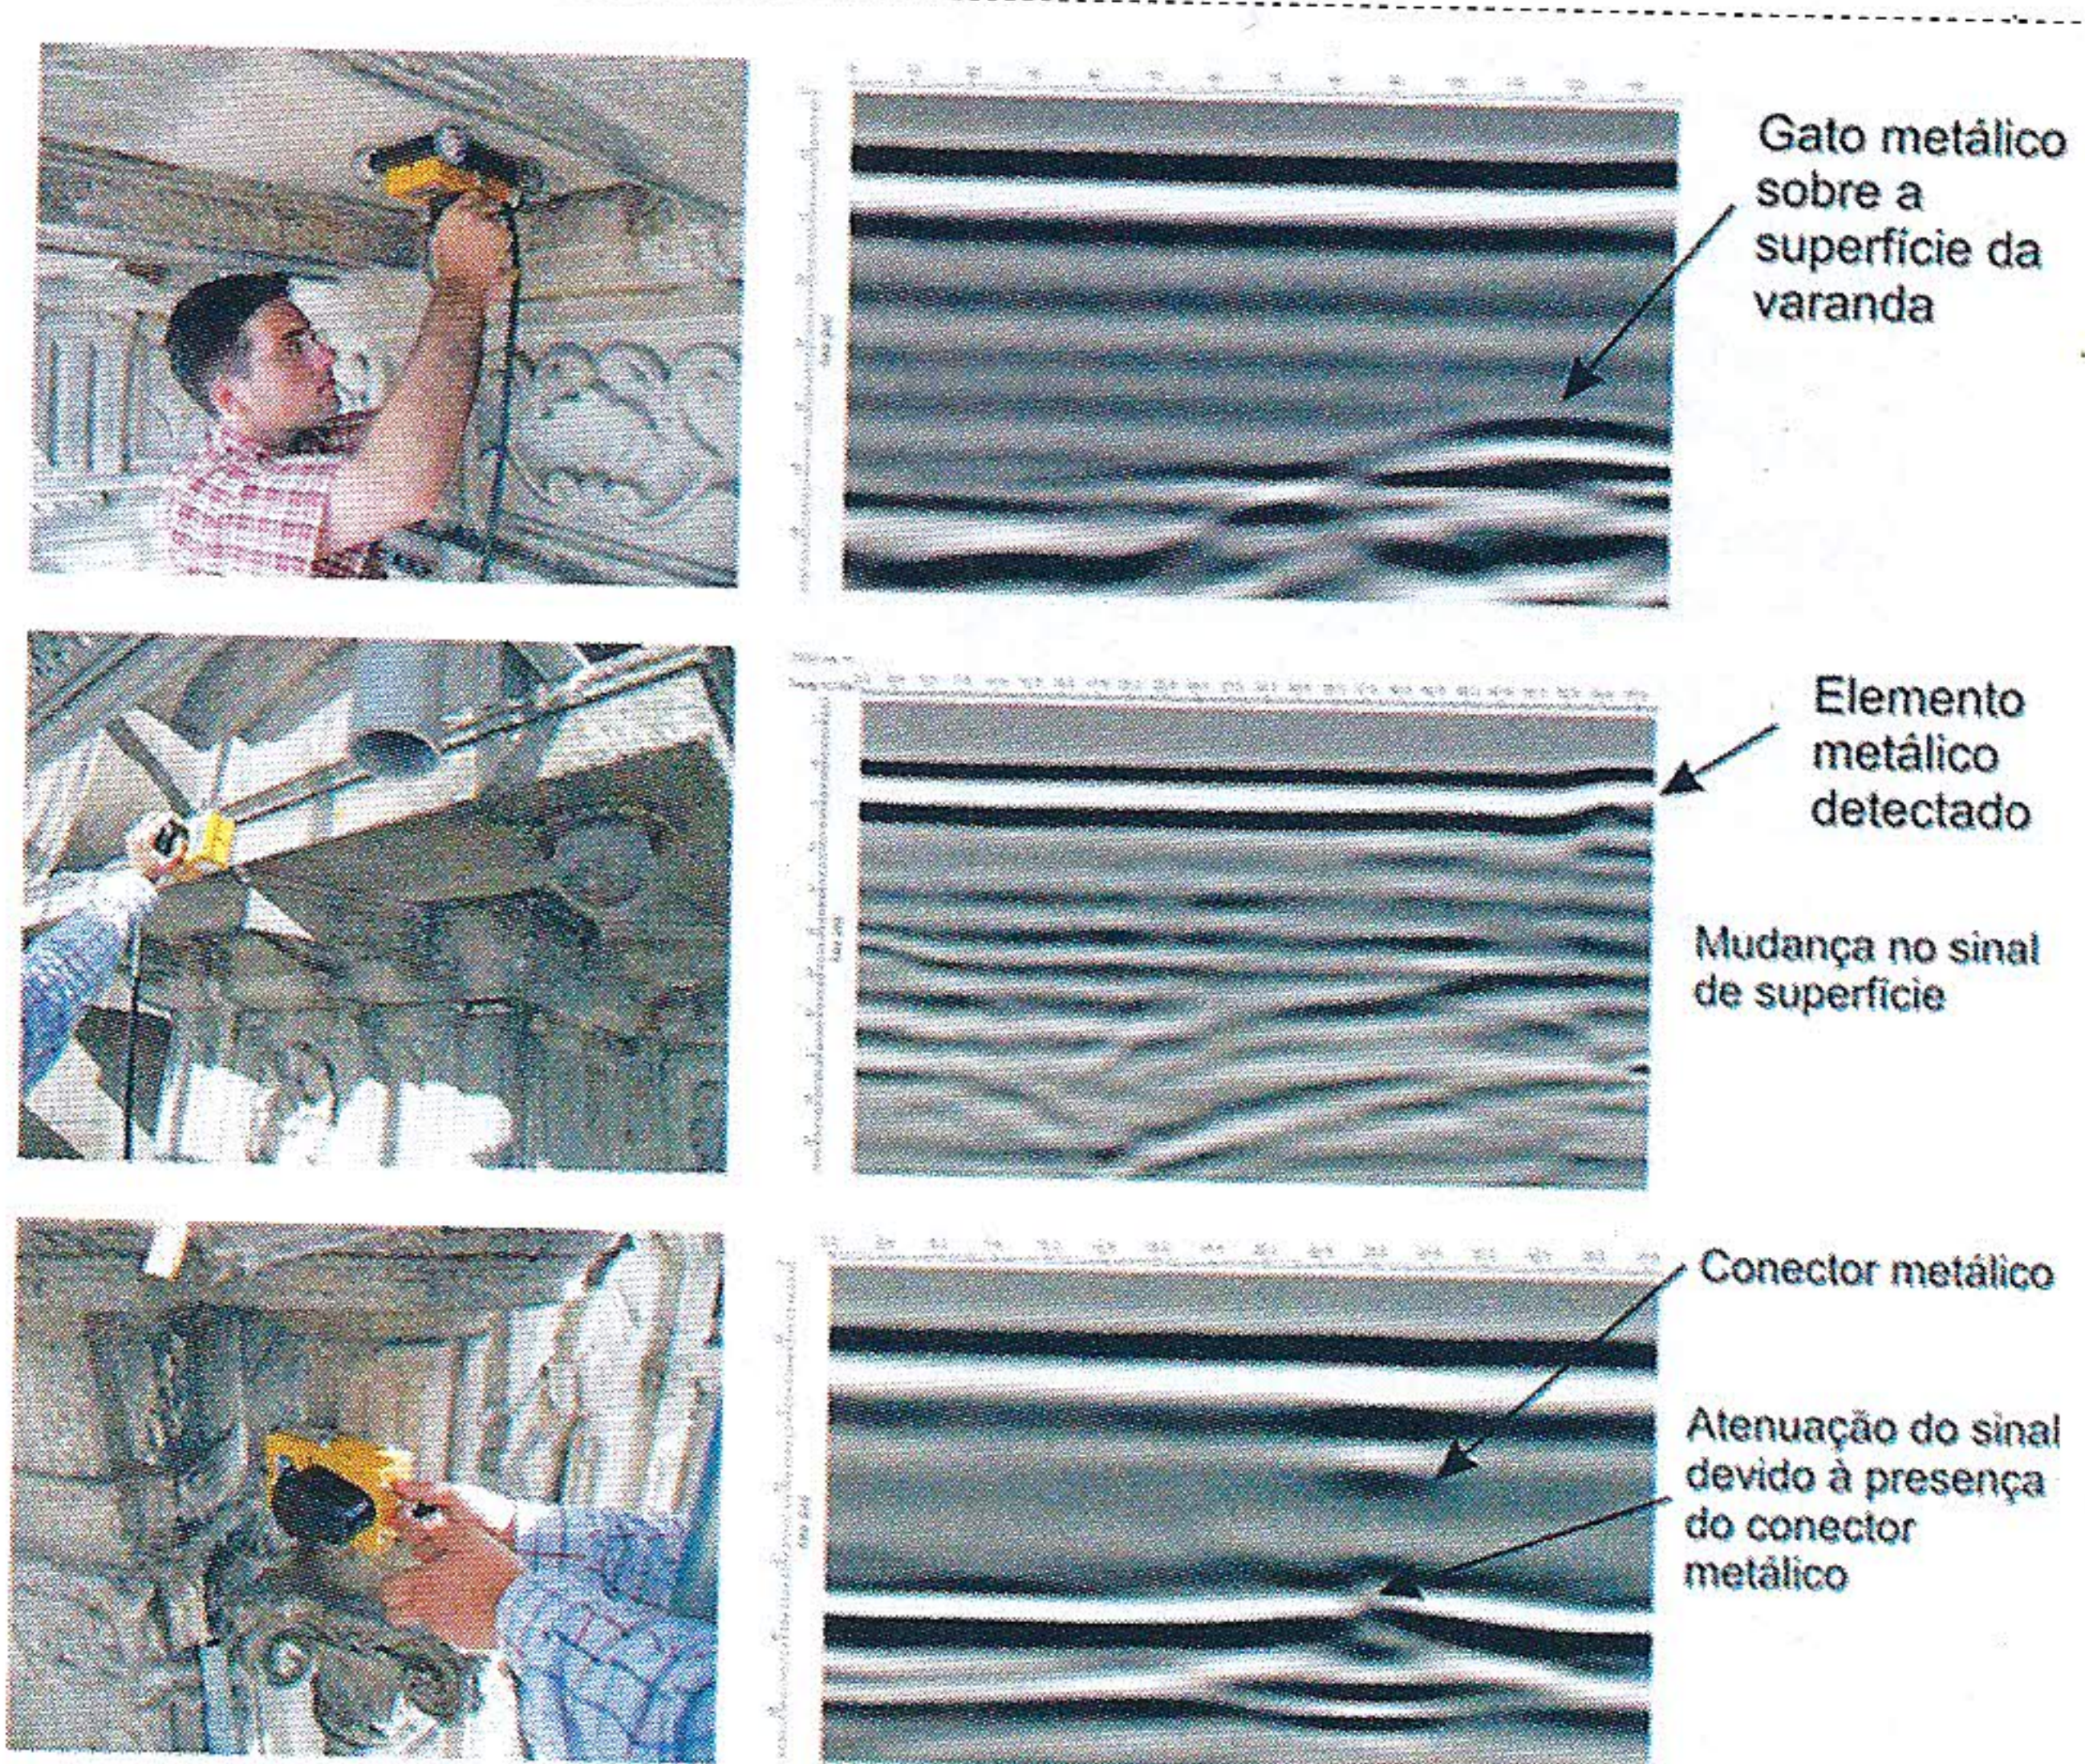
Detecção de conectores metálicos na fachada da Sé Catedral do Porto
